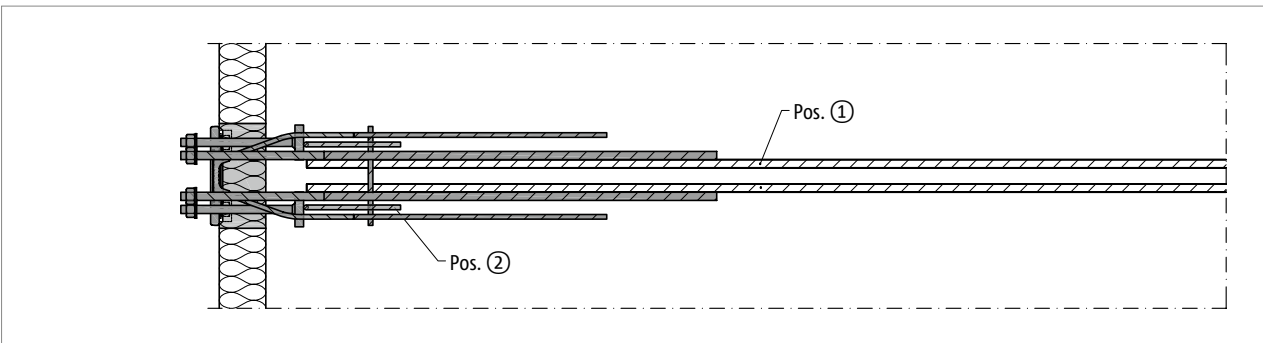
Schöck Isokorb® T Typ SKP-M1: Bauseitige Bewehrung, Grundriss
